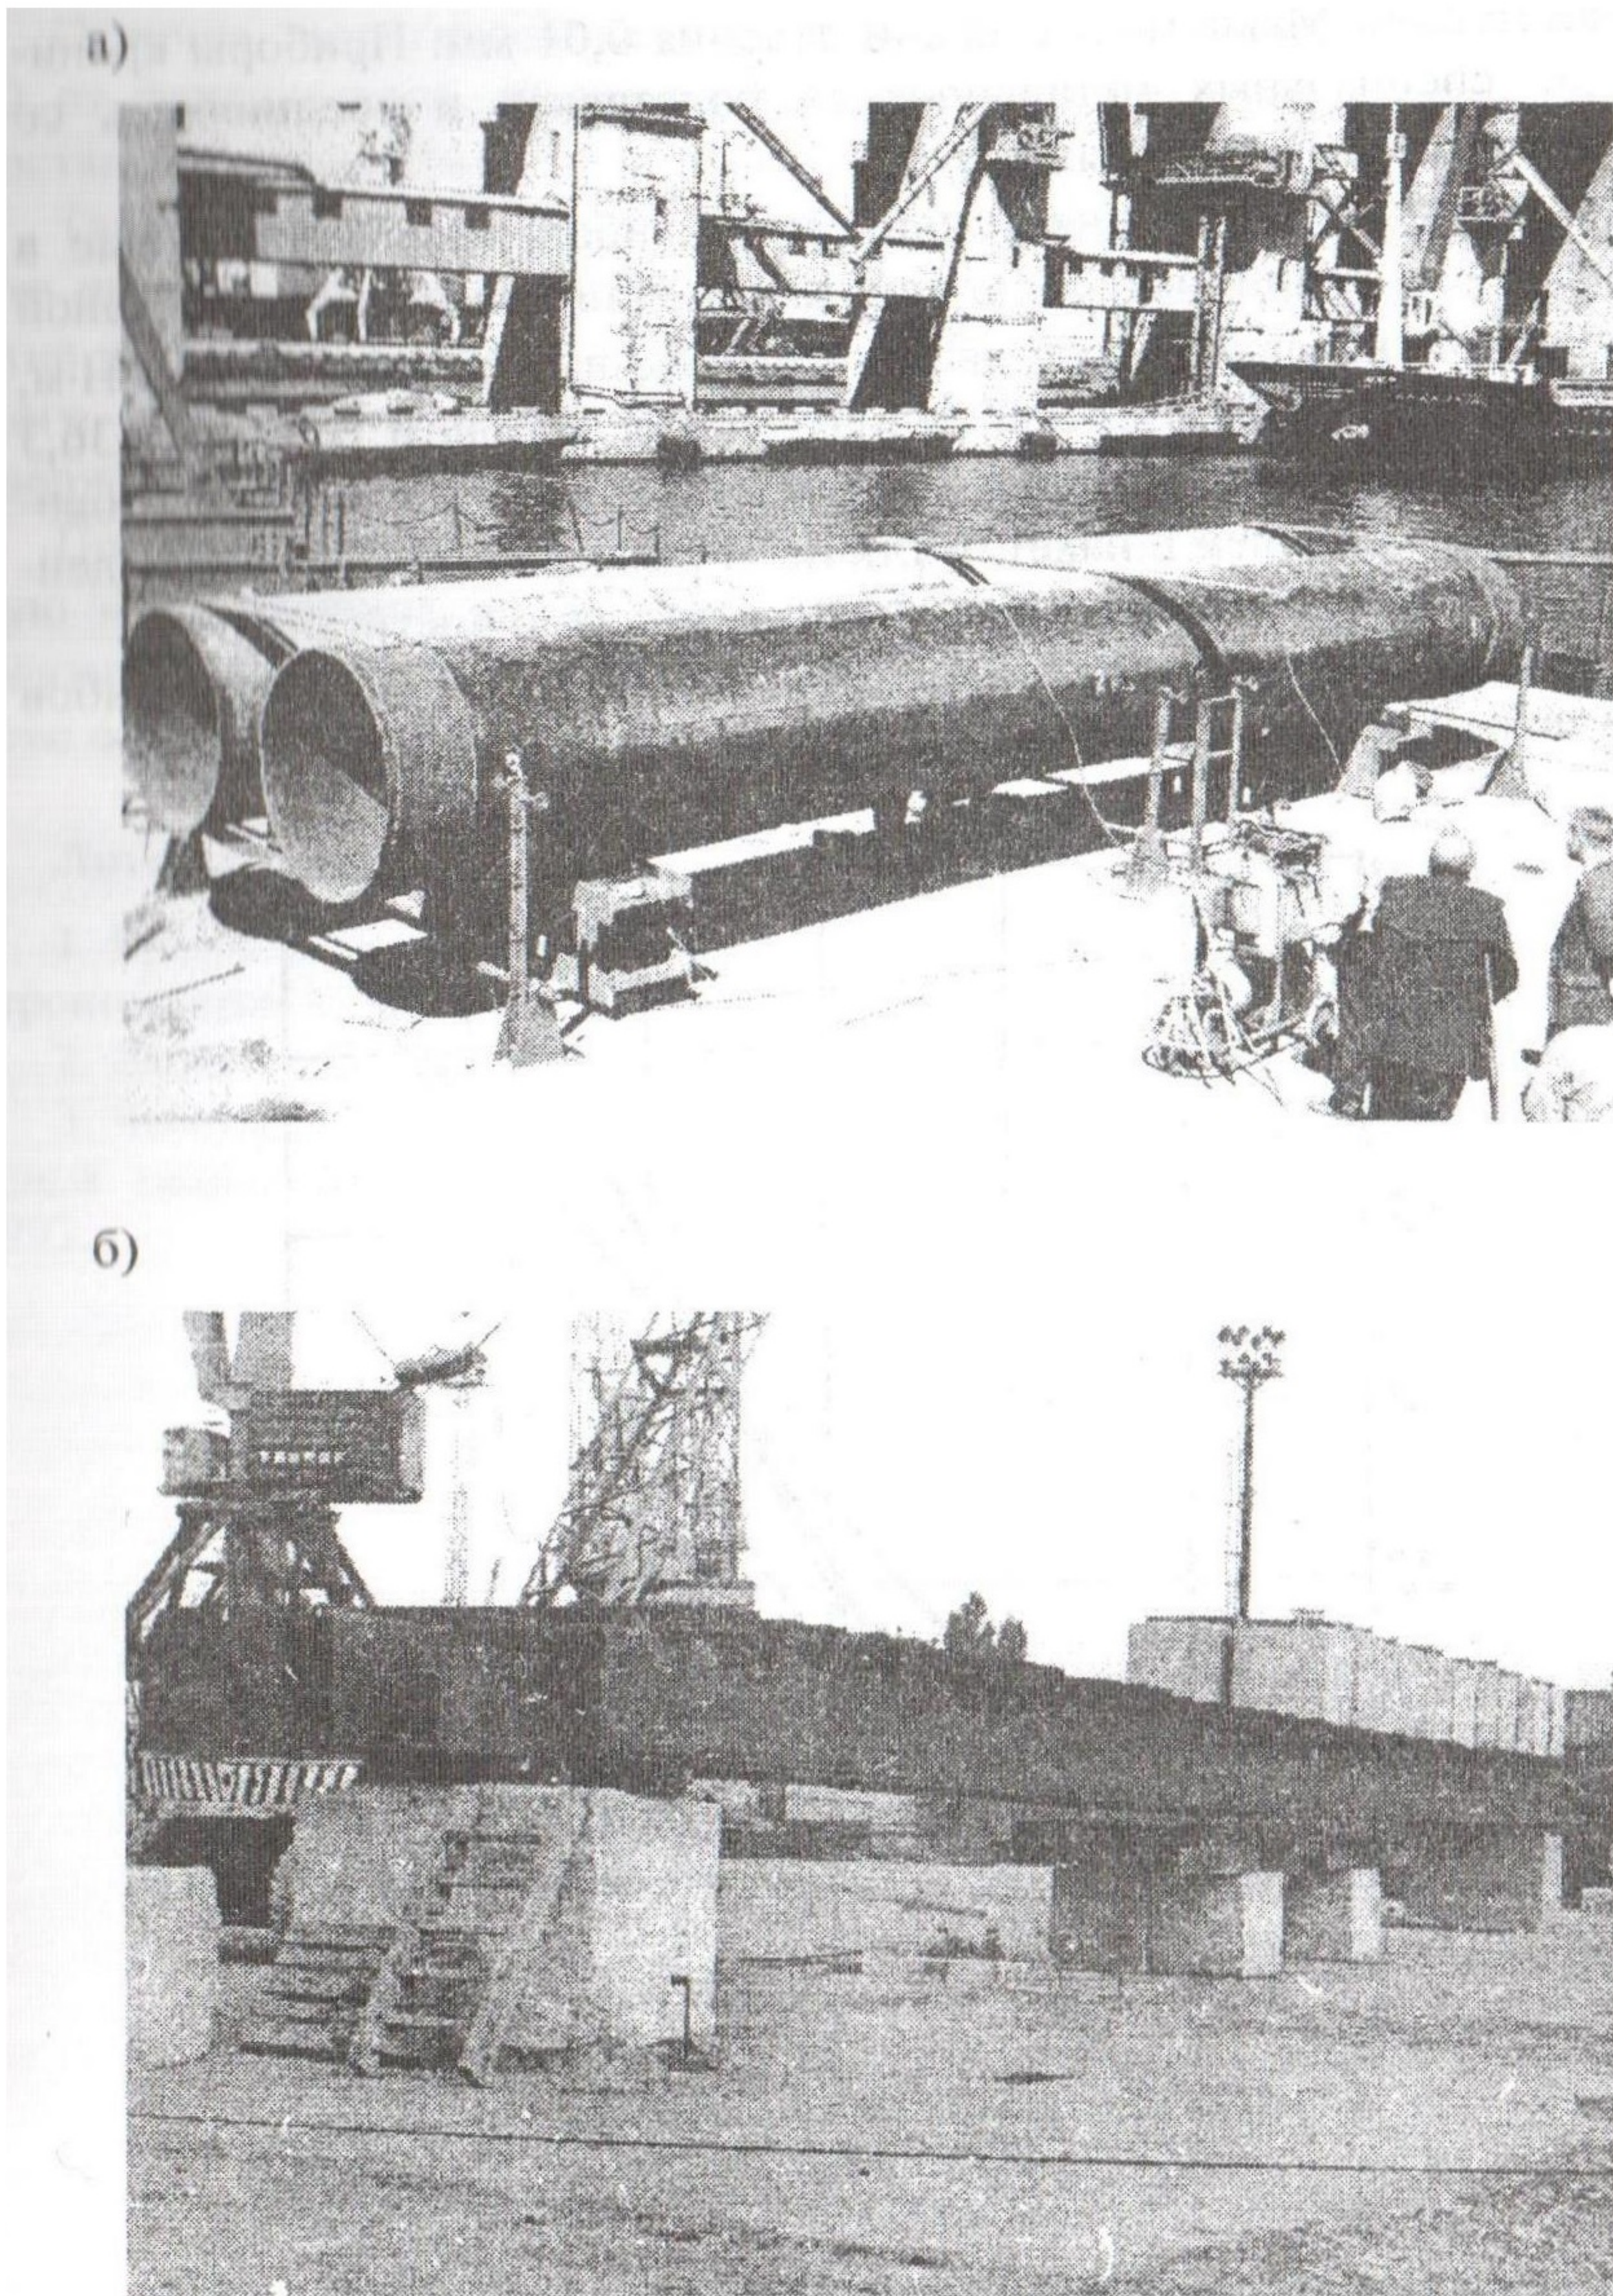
Порт Одесса. Натурные испытания несущей способности металлических конструкций: а) сварные трубы  $\varnothing 1420$  мм. б) сварной шпунт зетового профиля
